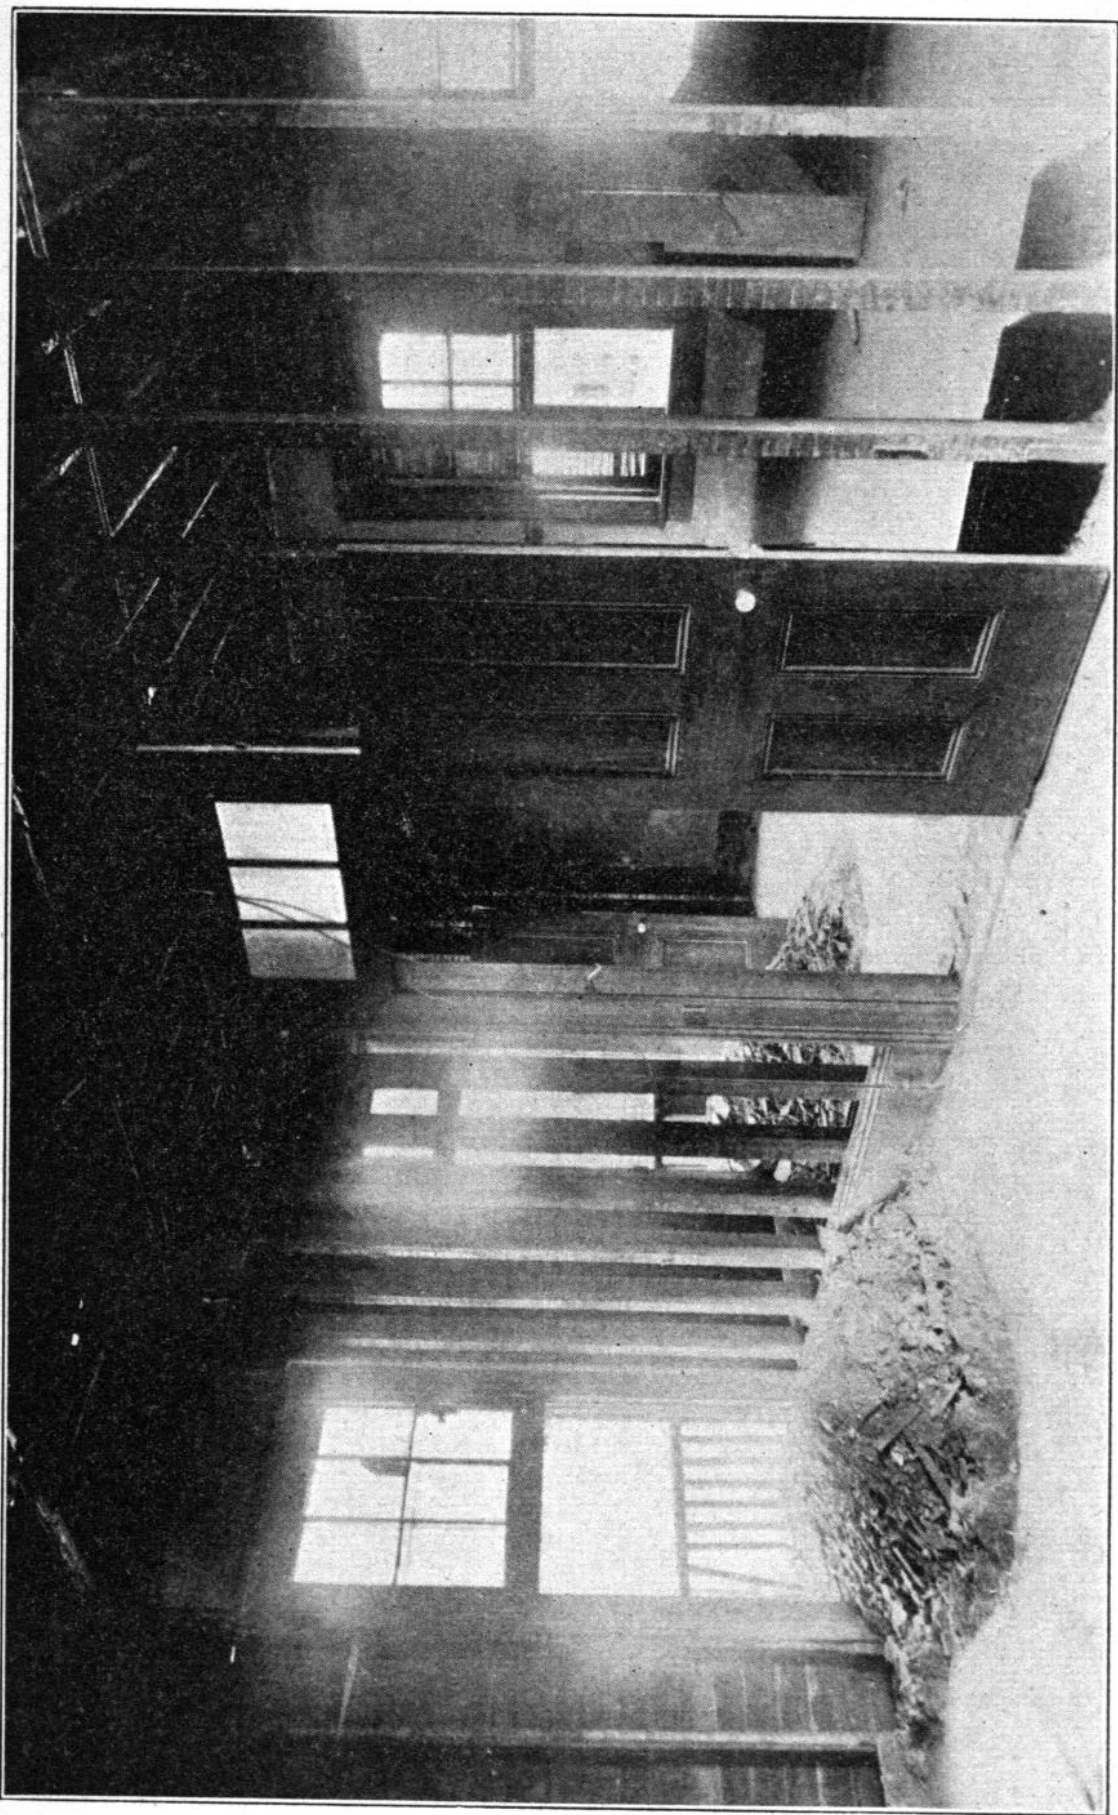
Tanto los cielos rasos como los pisos de esta casa se hallaban infestadísimos por ratas. En el sótano se ha quitado una capa del doble cielo raso y no se repondrá. La madera del piso ha sido suplantada con concreto (hormigón)
